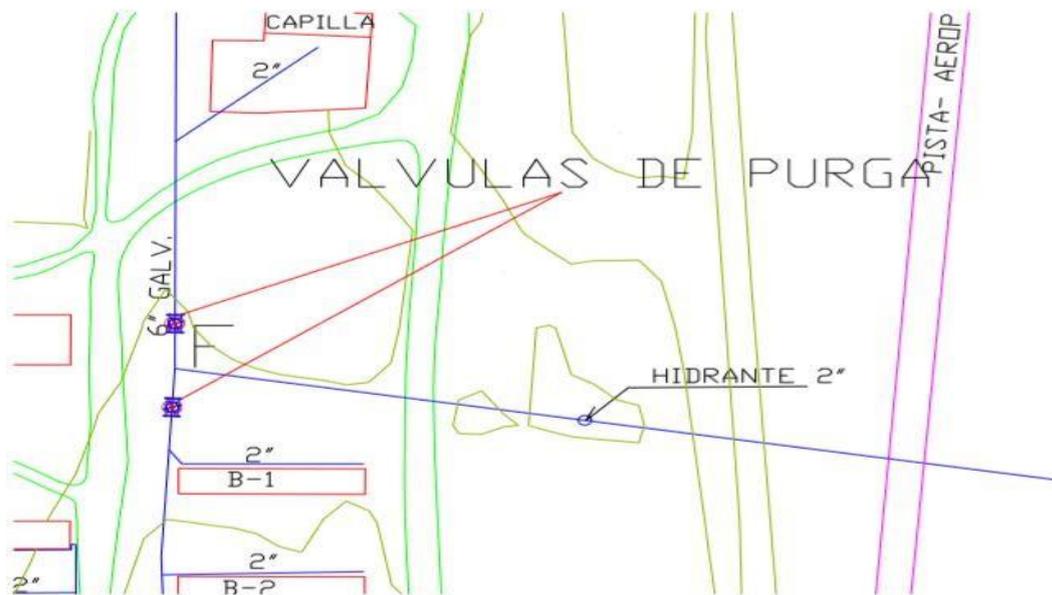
Plano en AutoCAD de la instalación de la válvula de purga.
